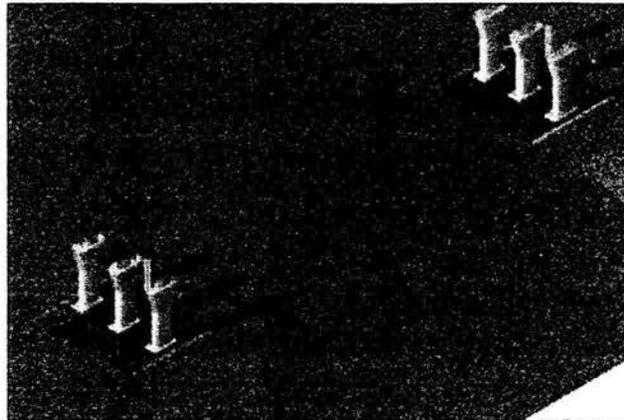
Distancia longitudinal de claros de traves TC
